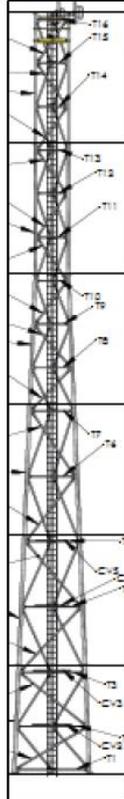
Exemple pylône tété conduite mise en place sue l'écluse de Beaulieu (Extrait Rapport ARTELIA Ref : 4660135 section A)
